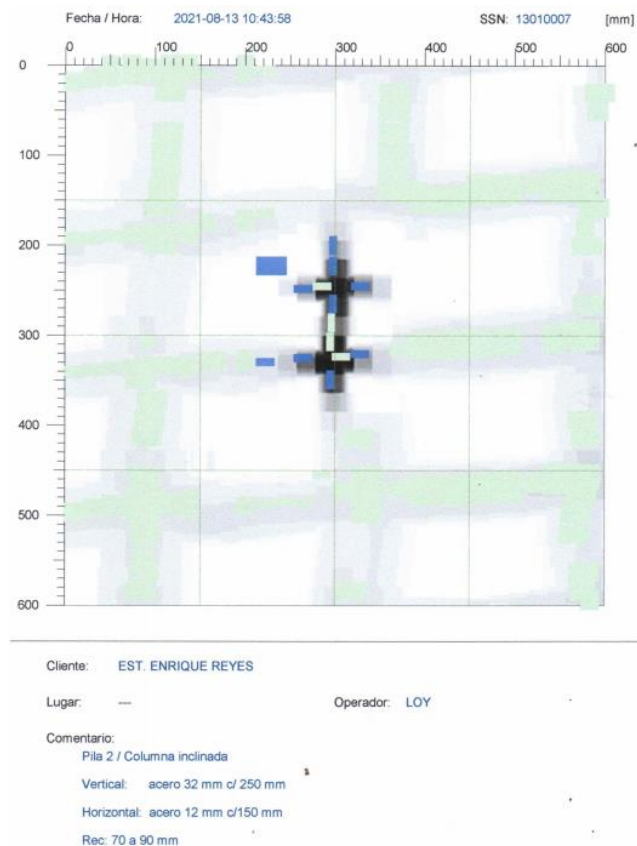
Armadura de pila #2. Fuente: (CEINVES)
